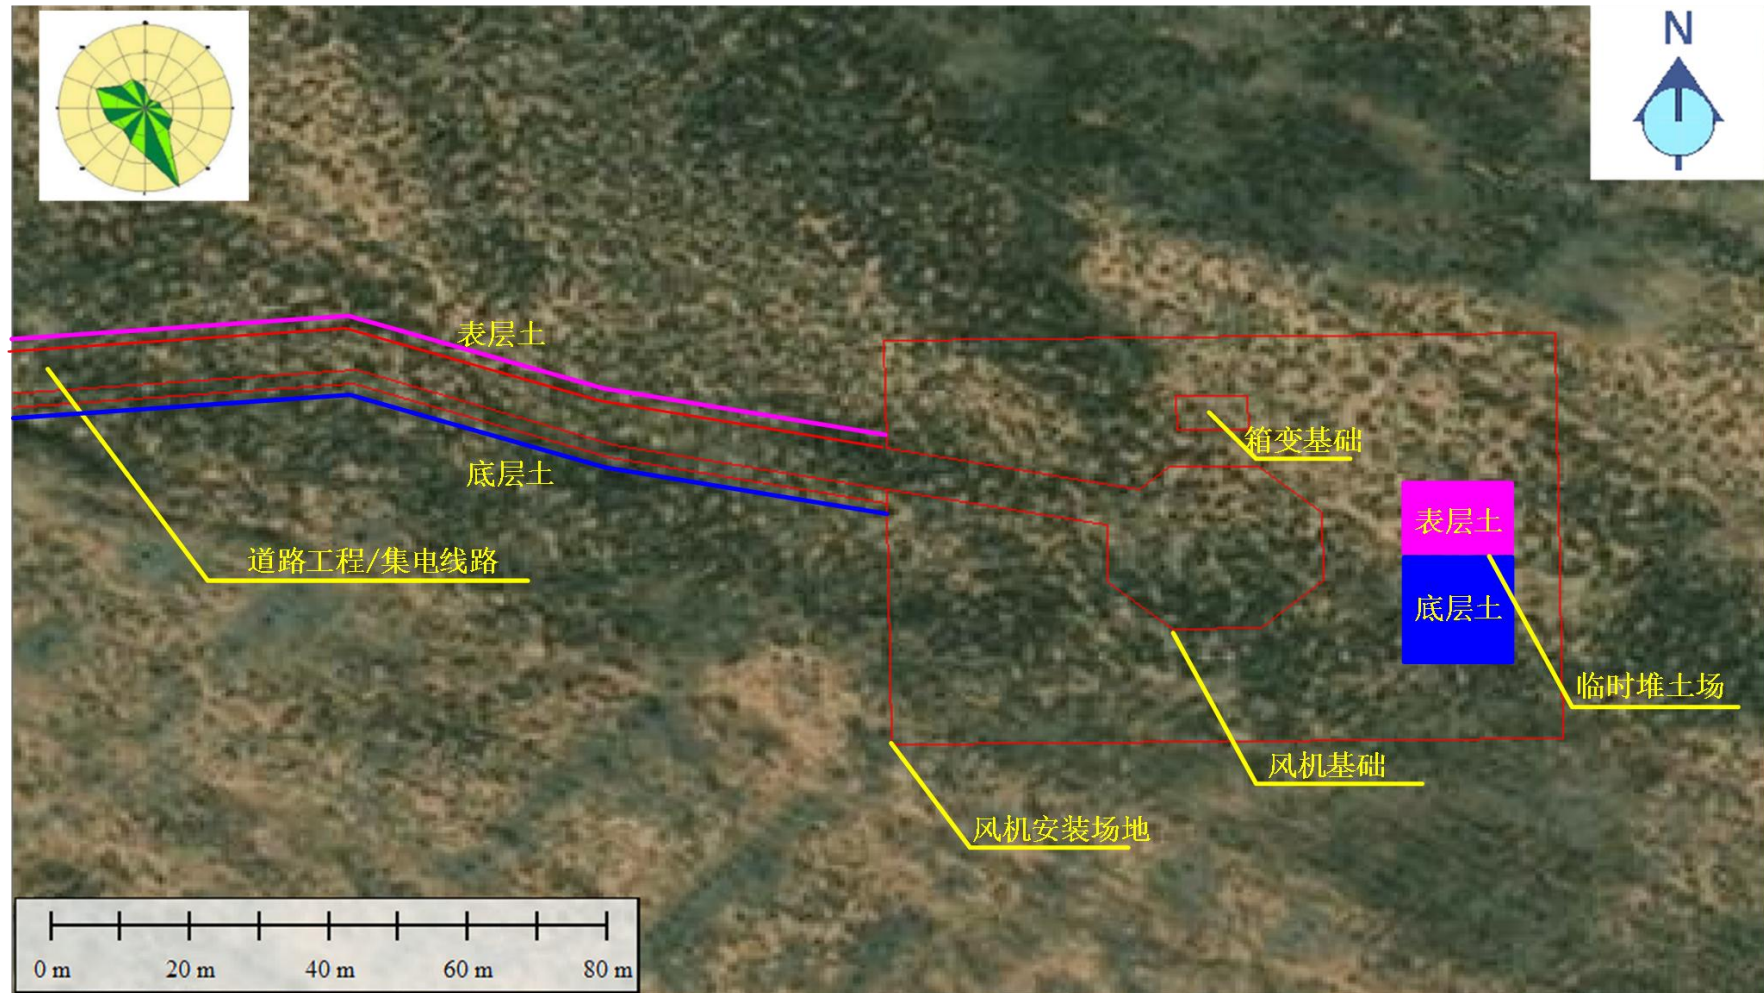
施工场地平面布置图（单个风机安装场地）
